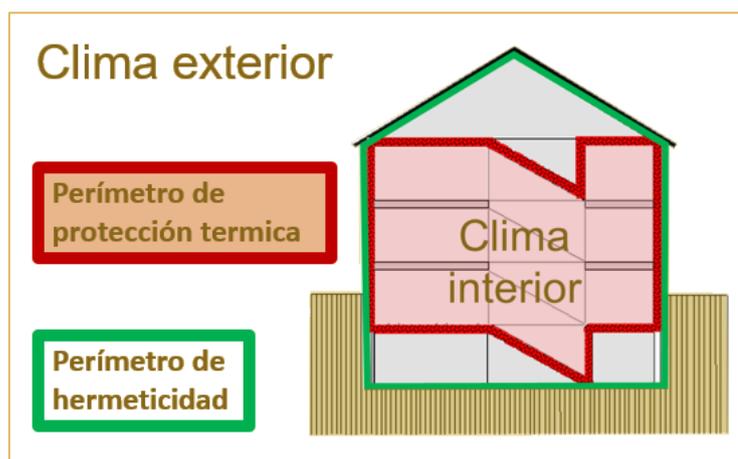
Explicación esquemática de la definición de los perímetros de hermeticidad y de protección térmica (Fuente: Armin Binz, 2021)
